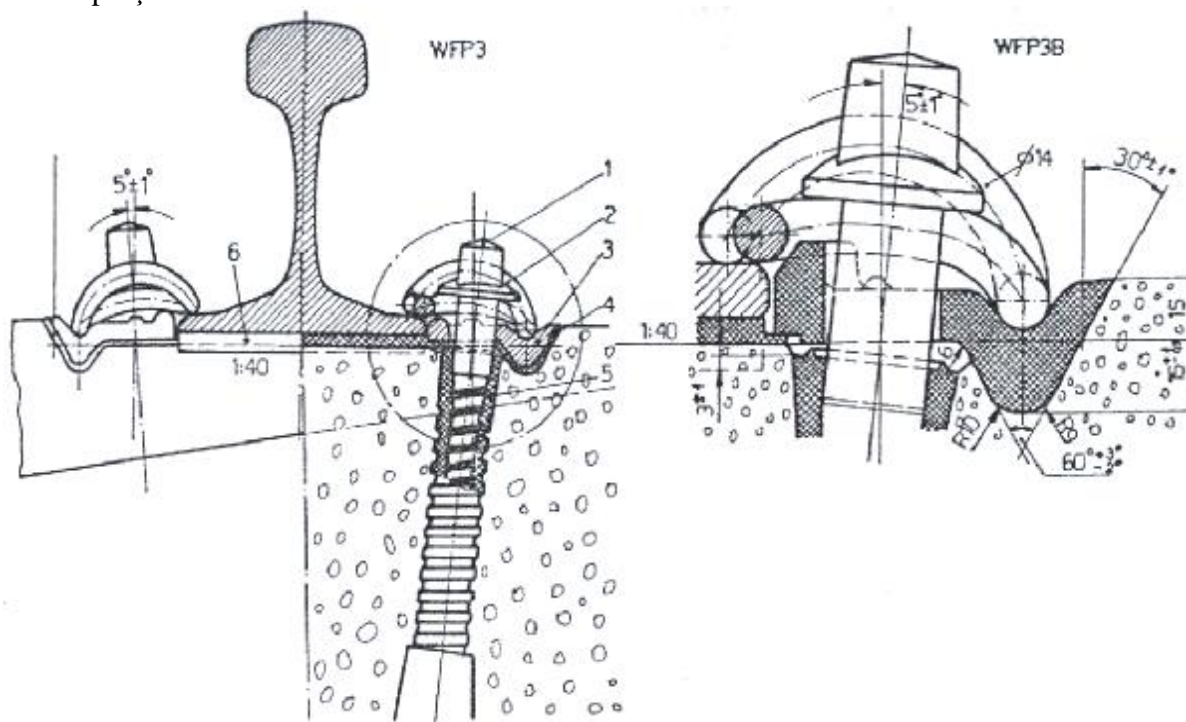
Prindere directă cu cleme elastice tip WFP3 – Austria.
